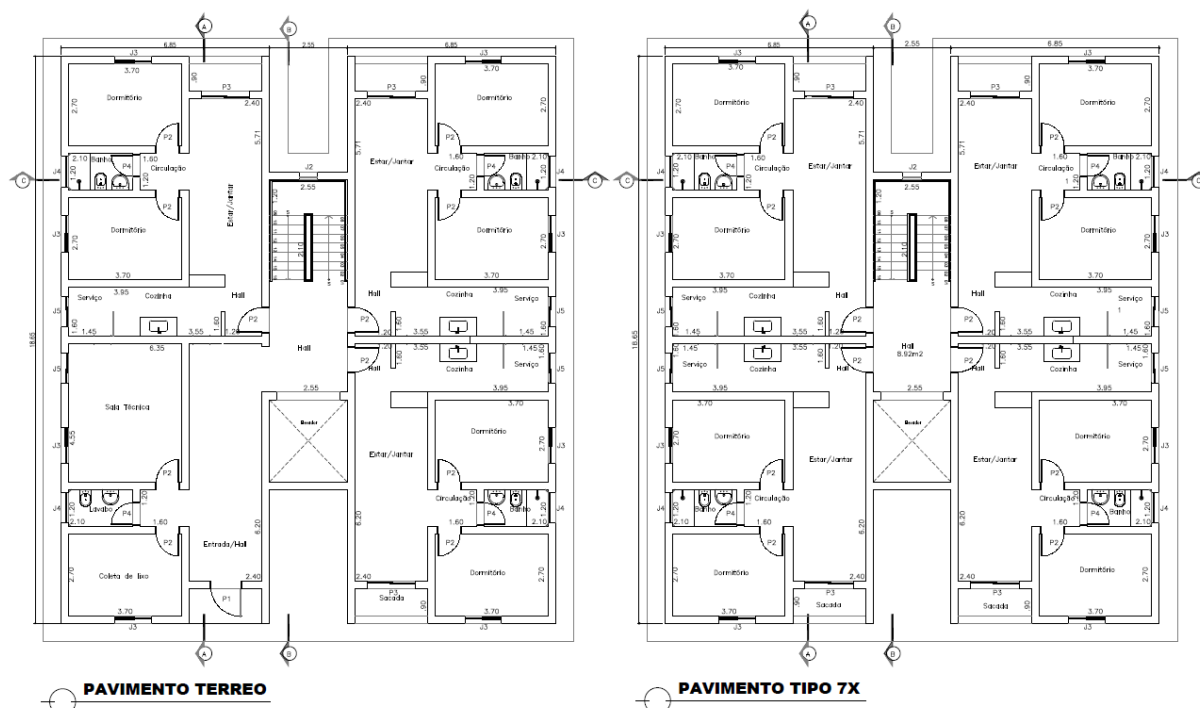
Planta Arquitetônica do Térreo e Pavimento Tipo do Estudo de Caso Modelo- Fonte: Os Autores (2016).
